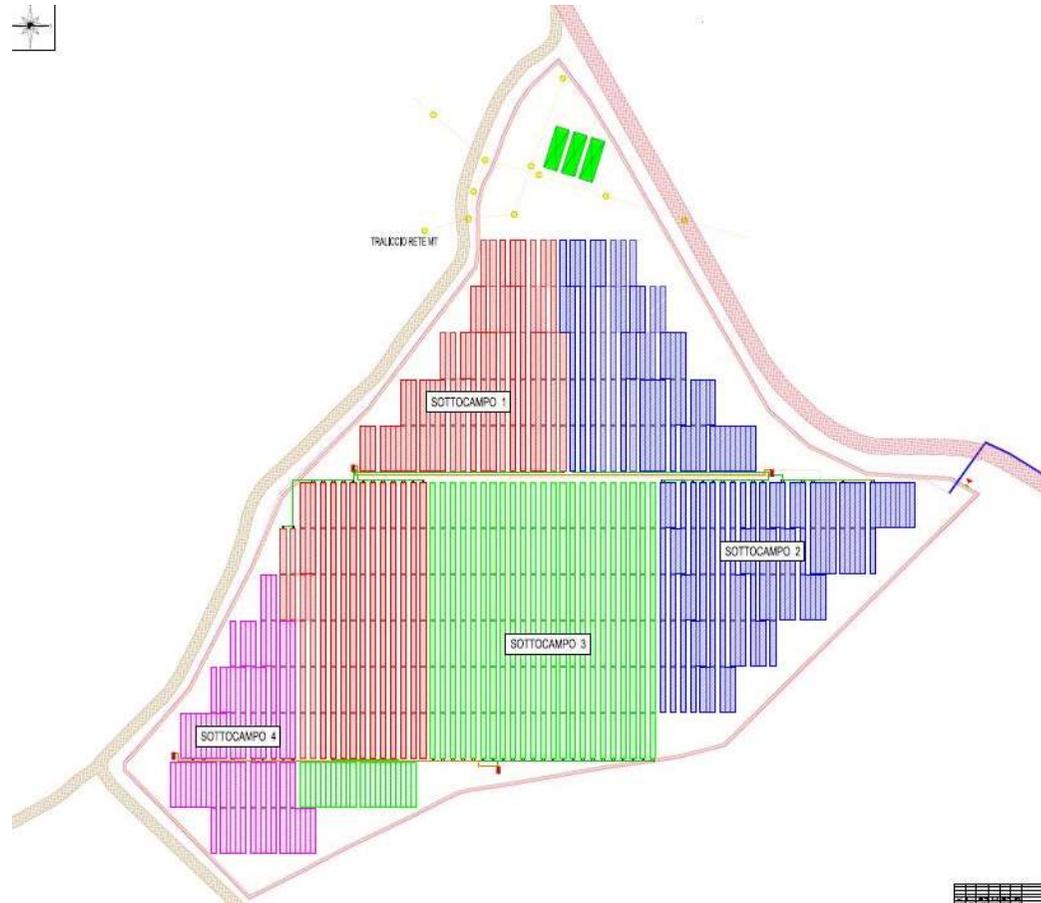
Stralcio planimetrico con indicazione dei sottocampi
